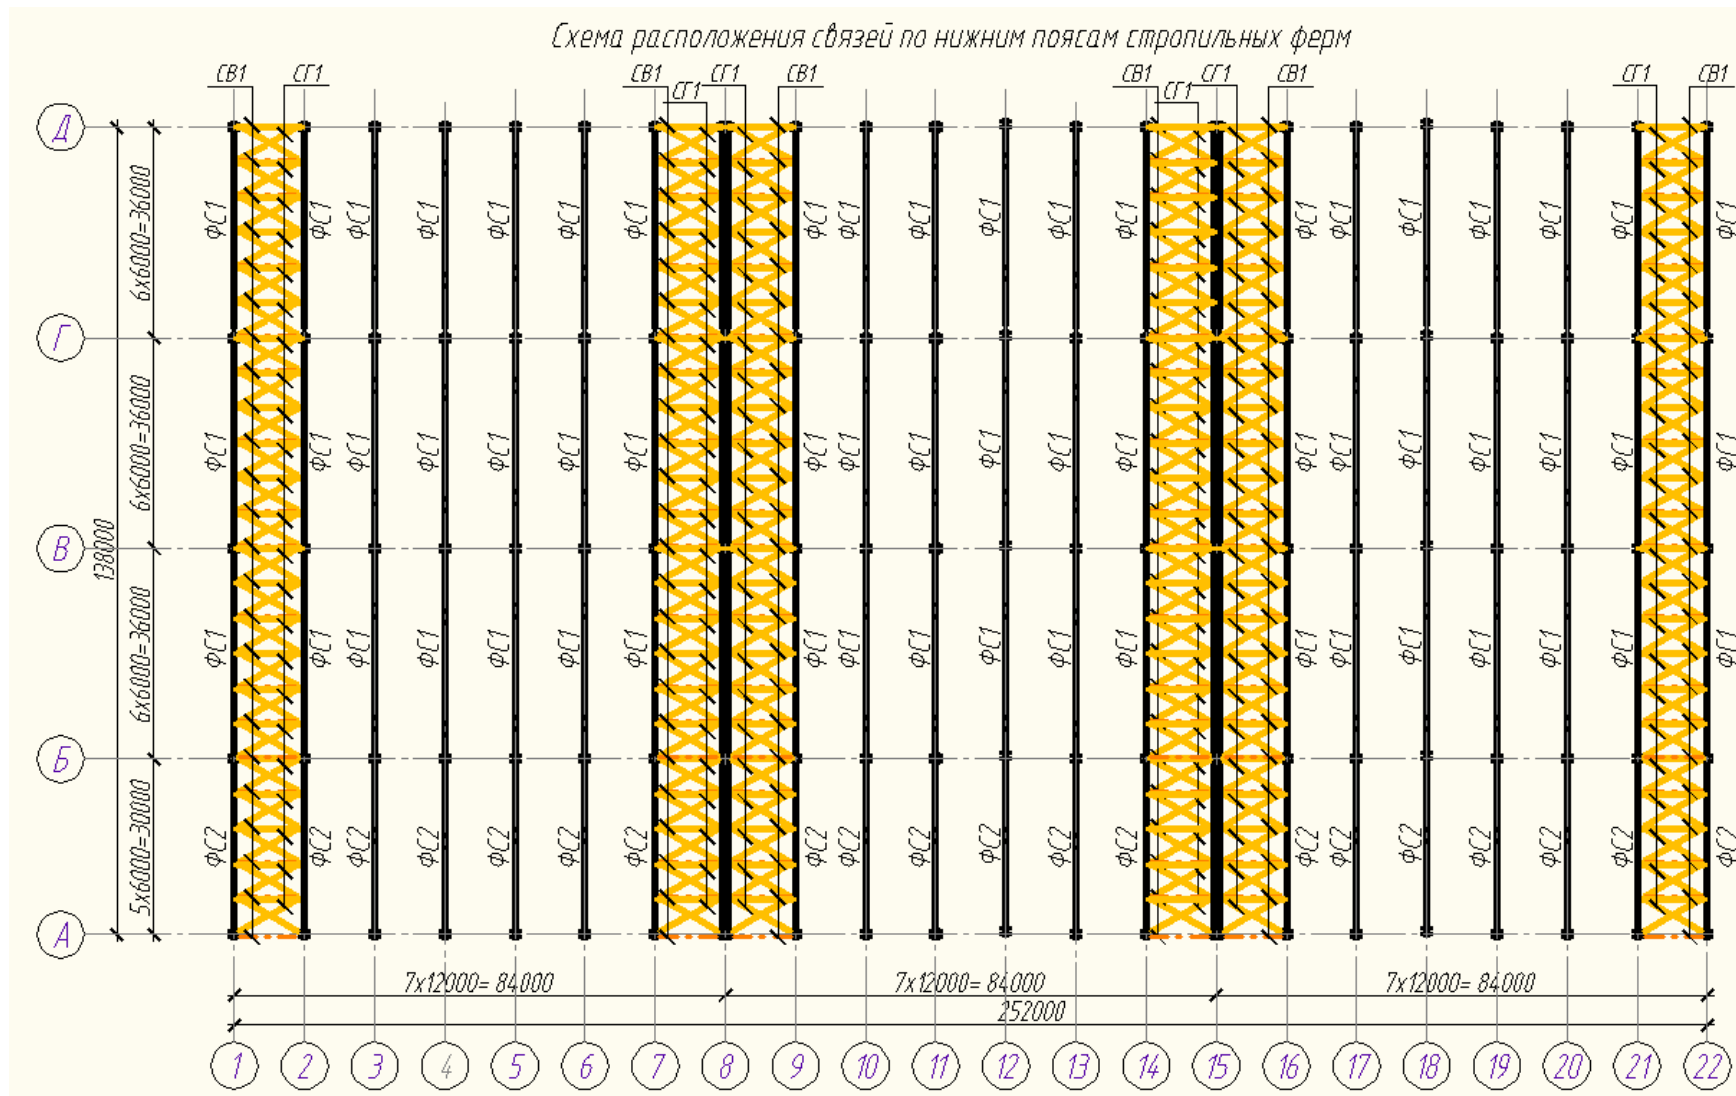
Схема расположения связей по нижним поясам стропильных ферм
